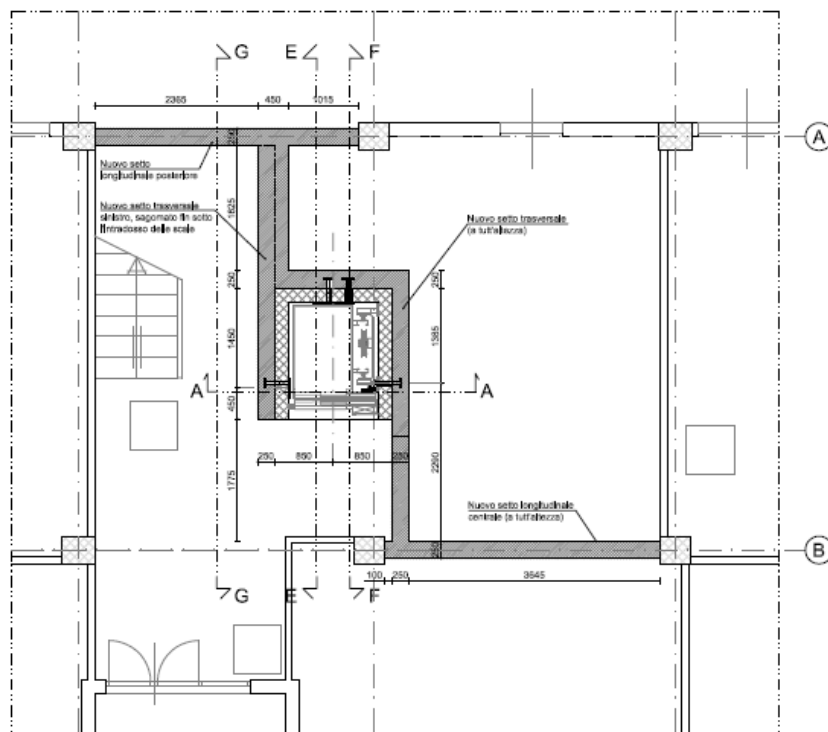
Stato di progetto – Struttura – nuovi setti al piano terra.
